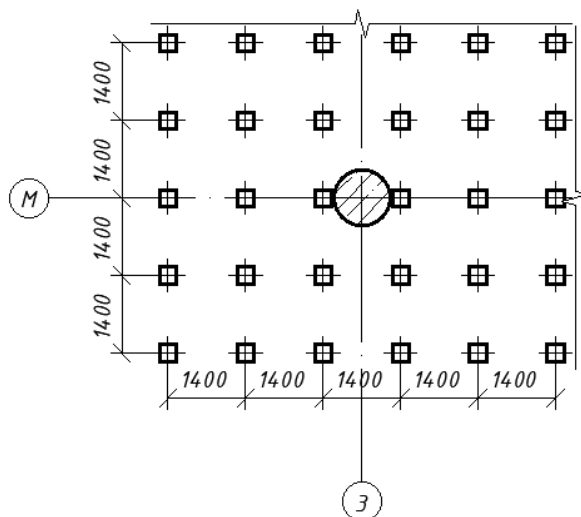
Схема расположения свай под фрагмент плитного фундамента
